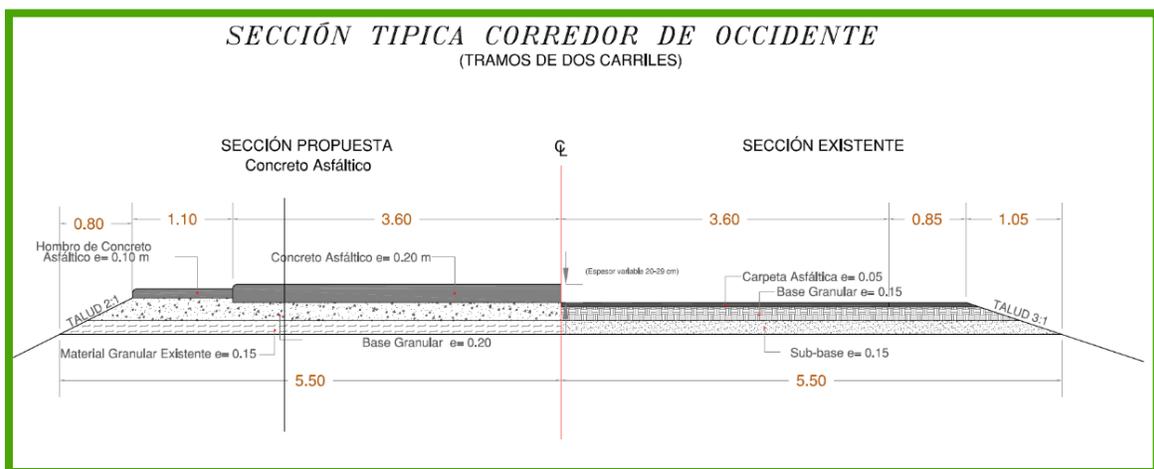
Sección Existente en el Tramo La Entrada-El Florido y opción propuesta para pavimentación con concreto asfáltico
